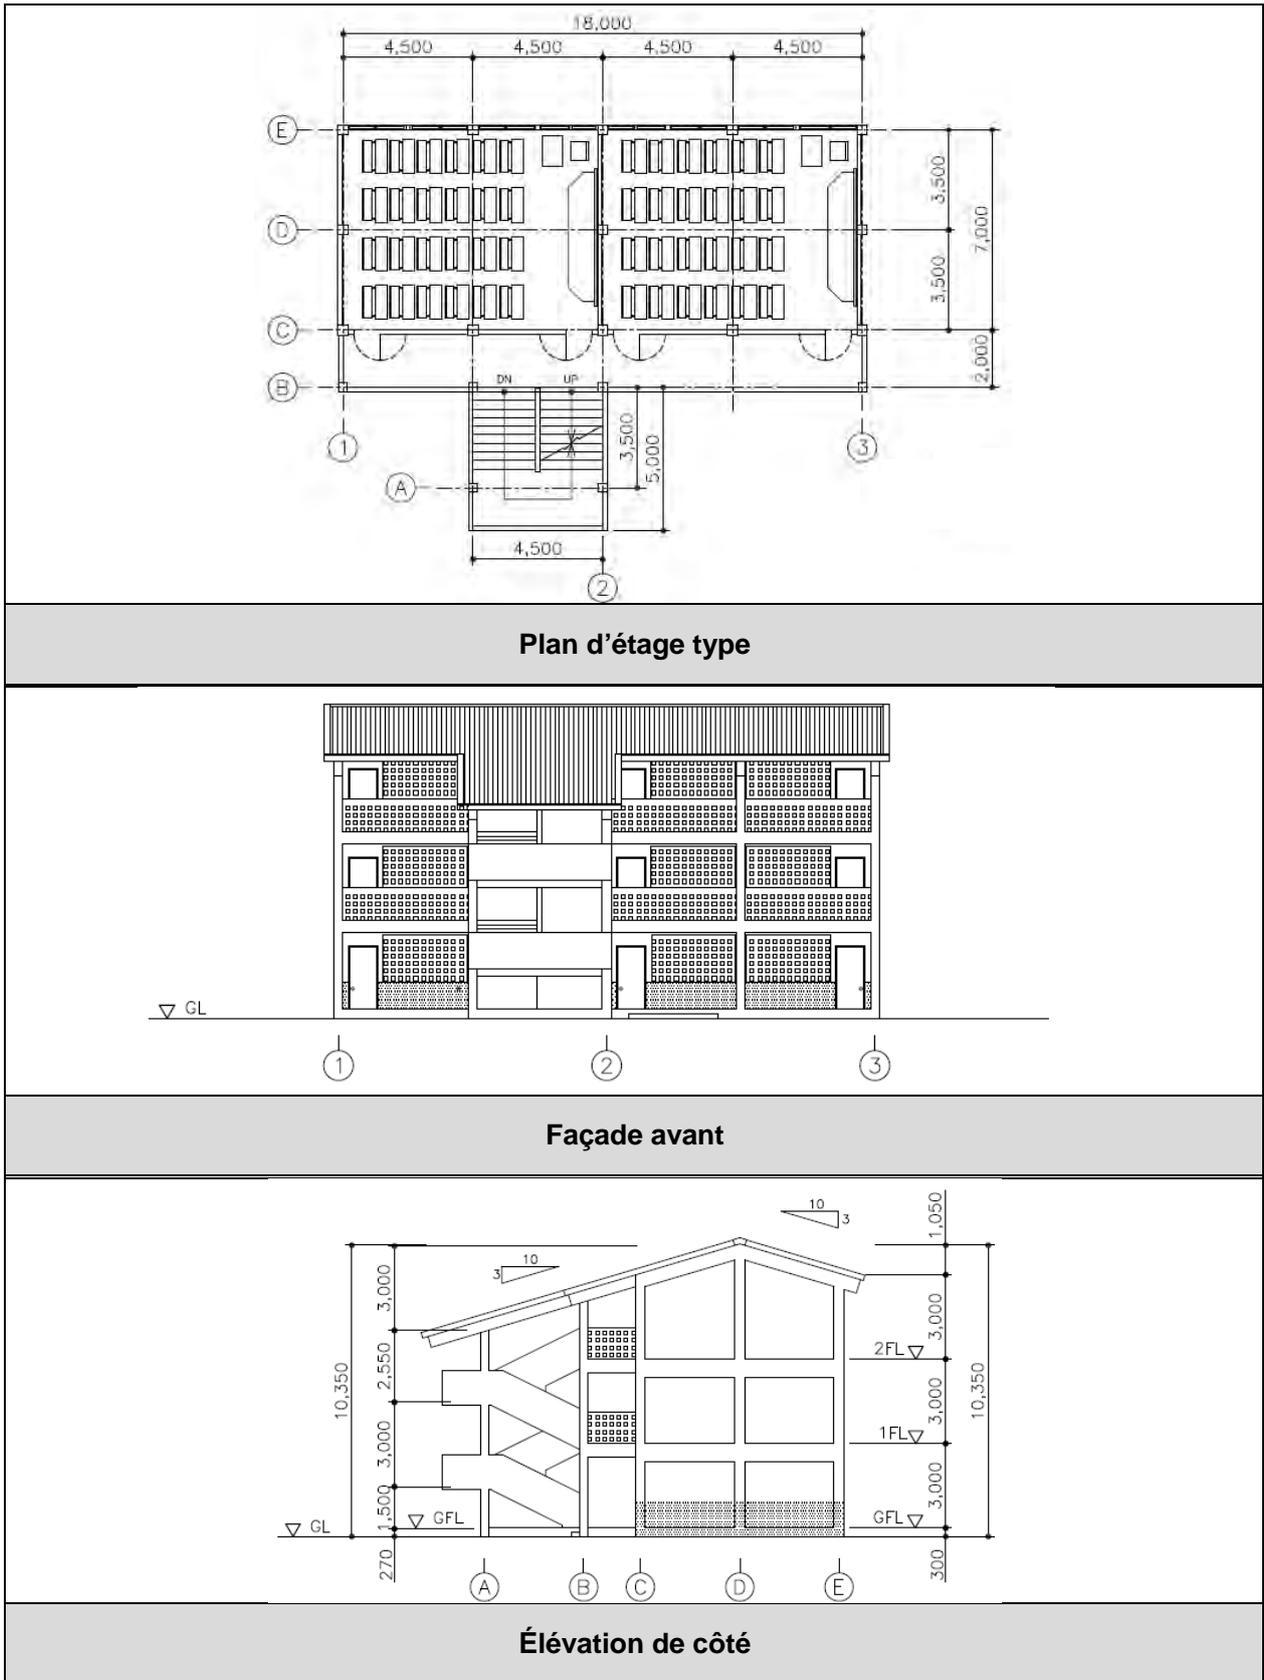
Plan type - Bloc de salles de classe du type C (2 SDC x 3 niveaux)
